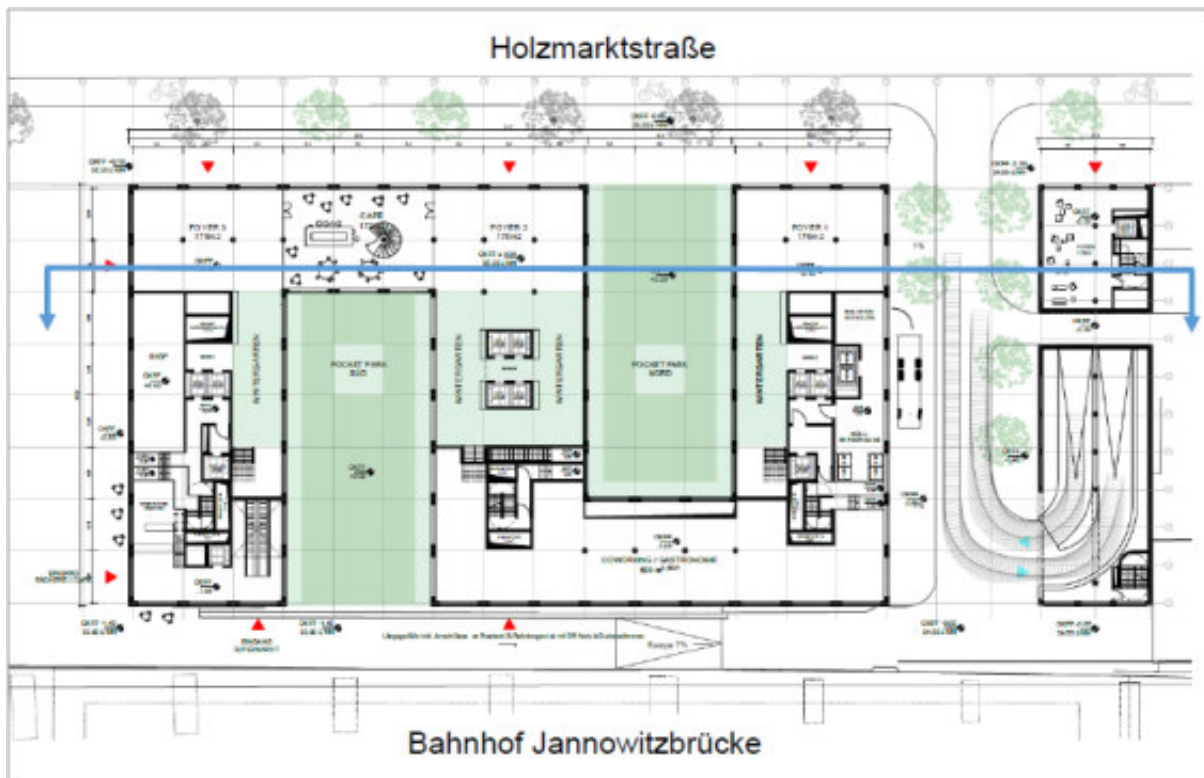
Übersichtsplan mit Darstellung des zentralen Stadthauses sowie dem Anbau JAH01
